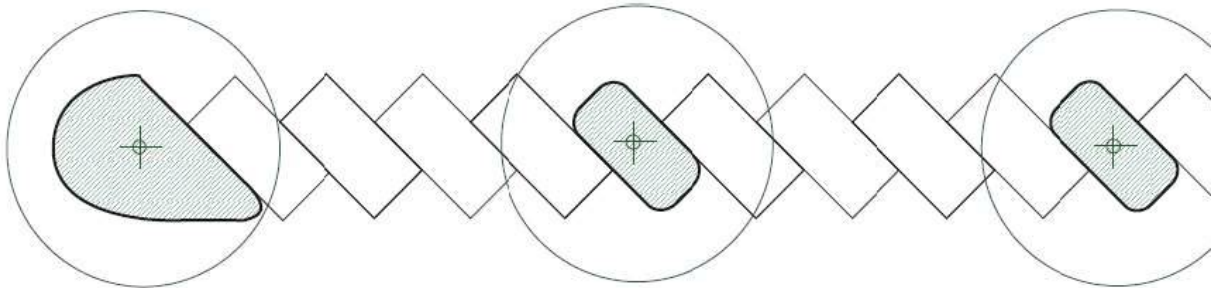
Detalle para siembra de árboles en ponches dentro de pavimentos
